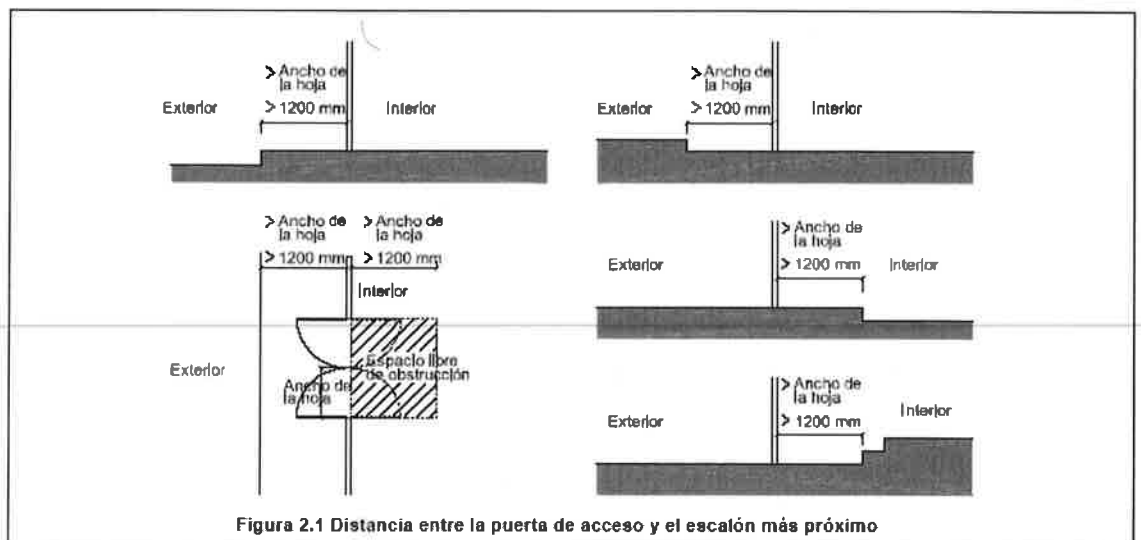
Distancia entre la puerta de acceso y el escalón más próximo
